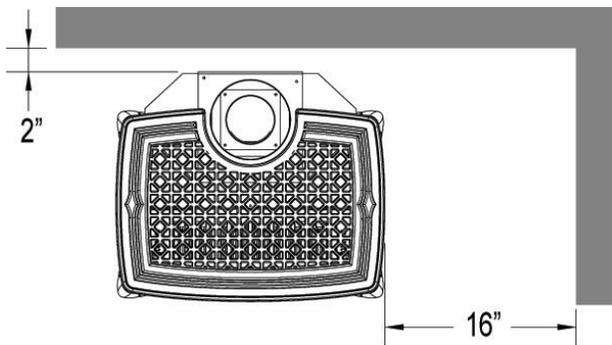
Dégagements Muraux Minimum Ventilation Horizontale
